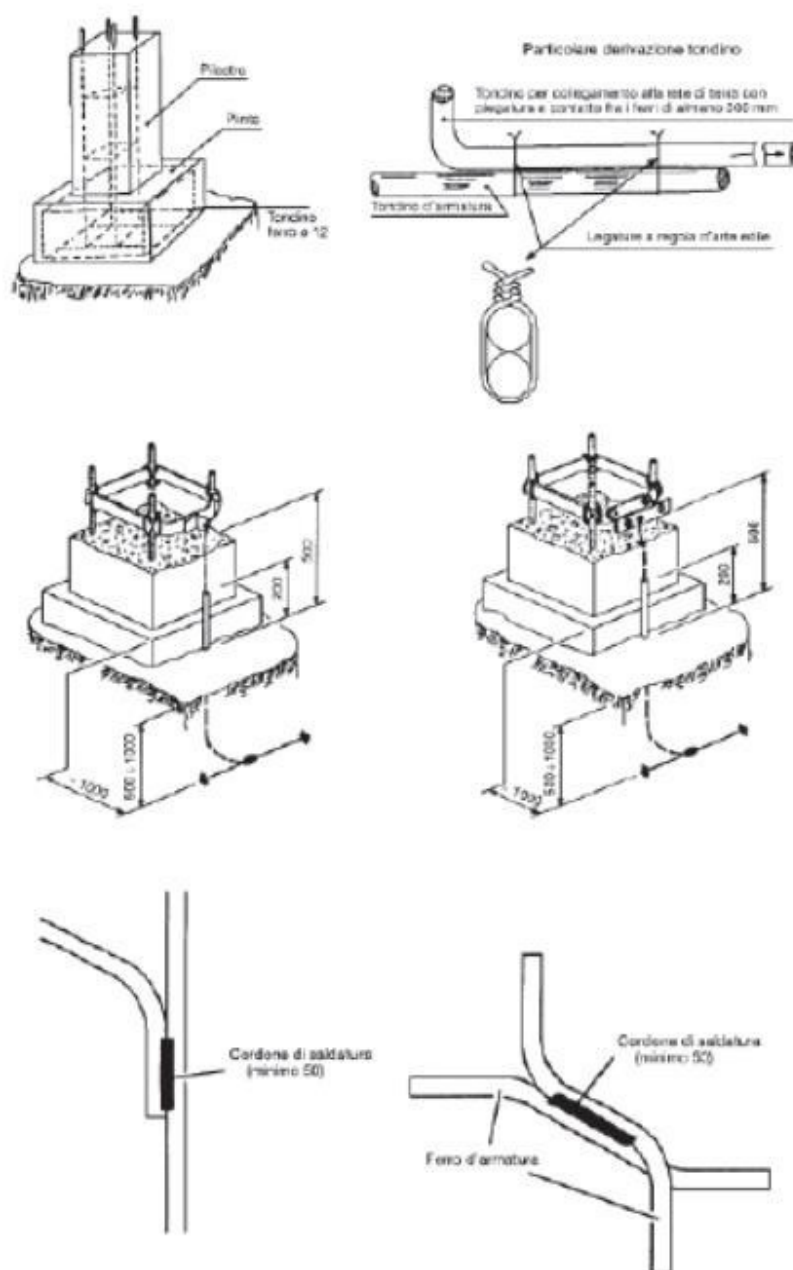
Esempi di plinti di pilastri e di connessioni ai ferri dell'armatura (dimensioni espresse in mm)
